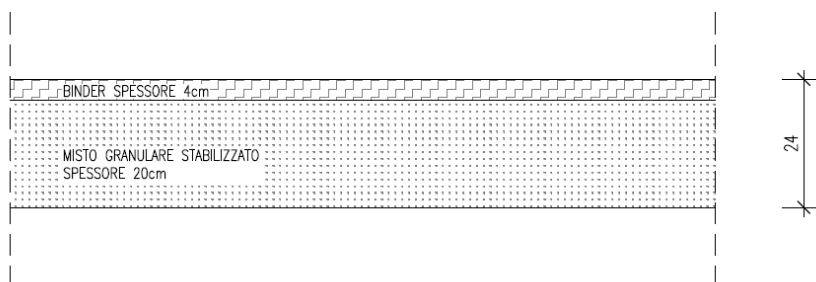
Pavimentazione flessibile per strada e piazzale
